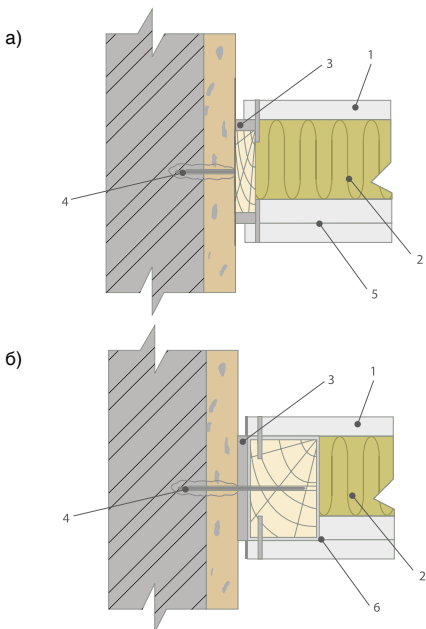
Примыкание каркасно-обшивных перегородок к стенам
